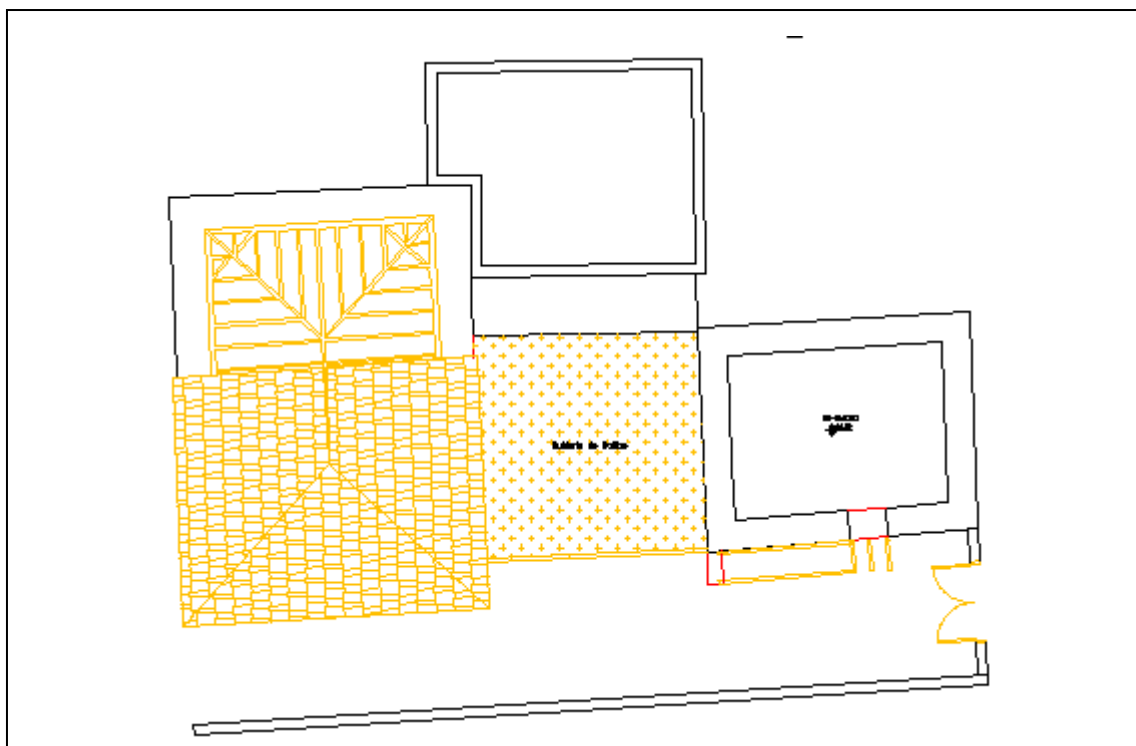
Elaboración propia. Fachadas y planta. Casa las Vistas.
